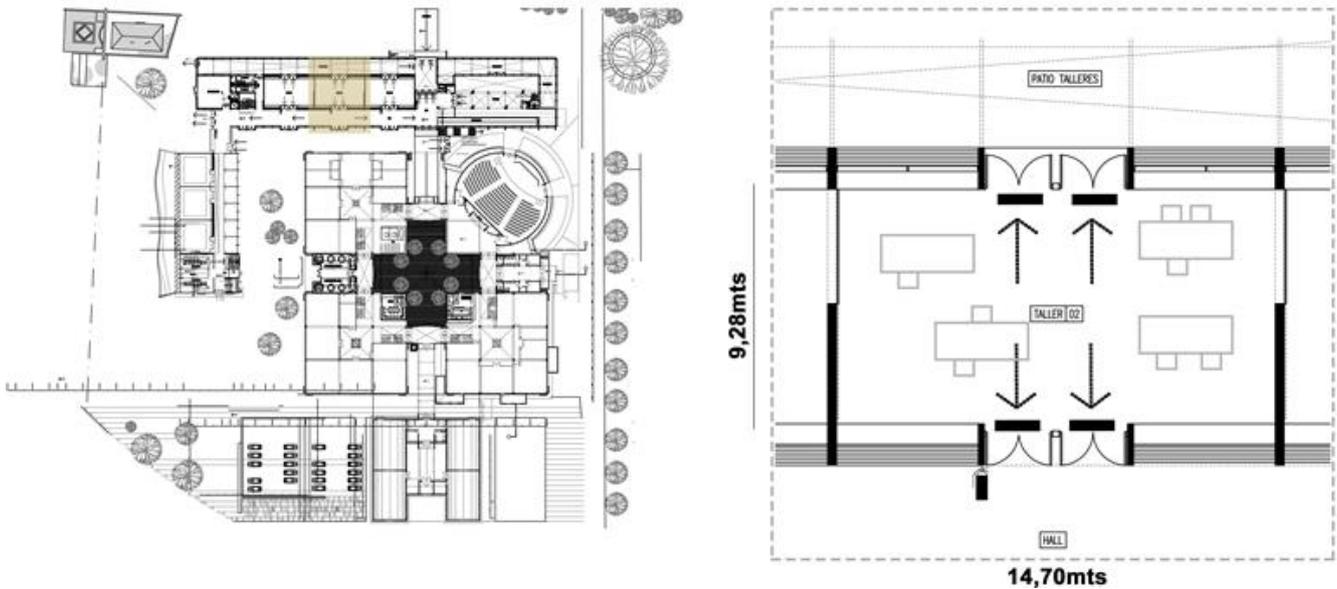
Planimetría General del Edificio con ubicación del local y Planta General del Aula
